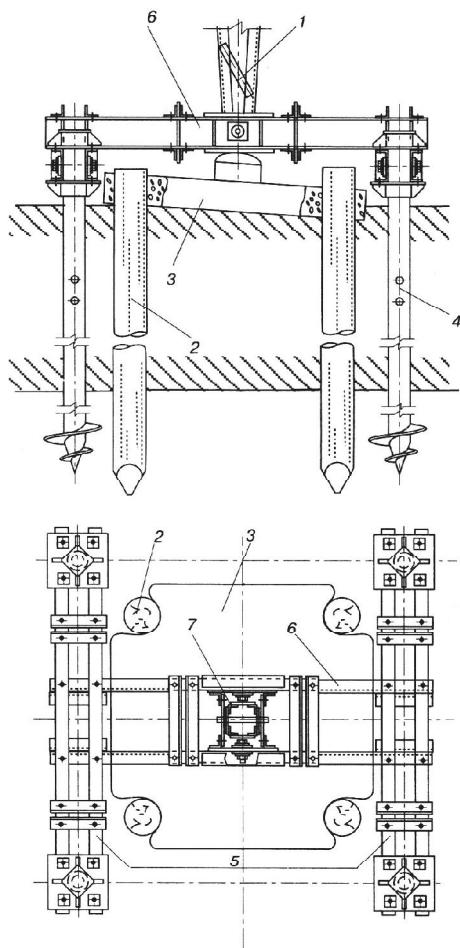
Фундамент на винтовых сваях для опоры ПОМ-220.
